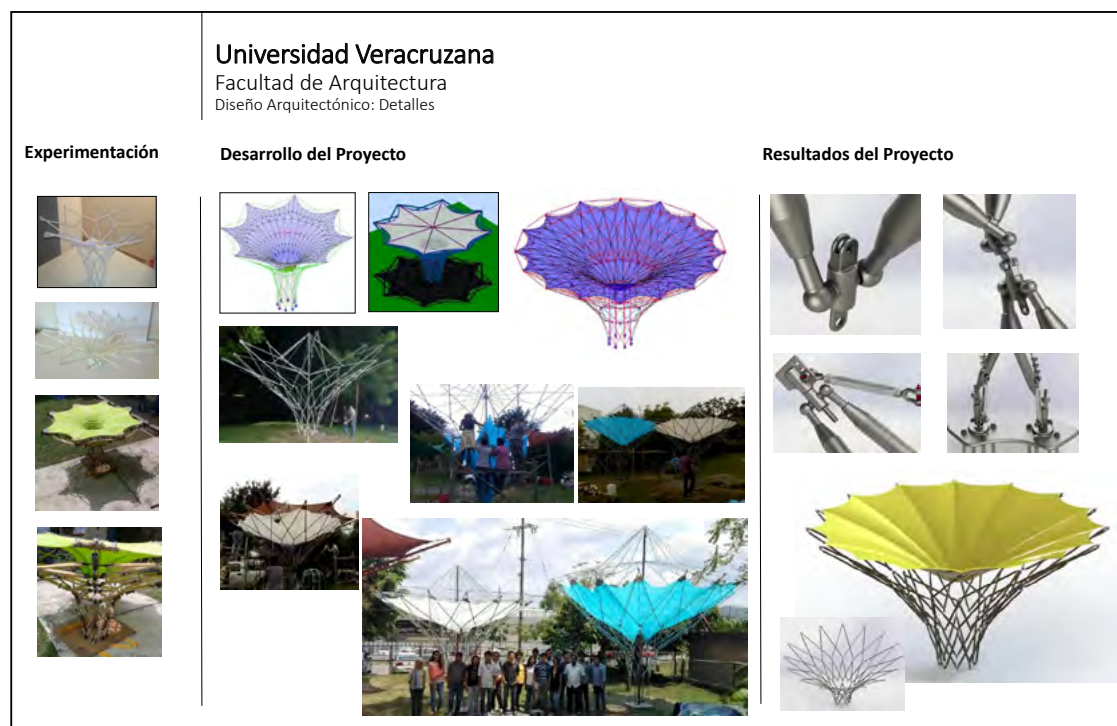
Propuesta de cubiertas ligeras: paraguas plegable tensado.
